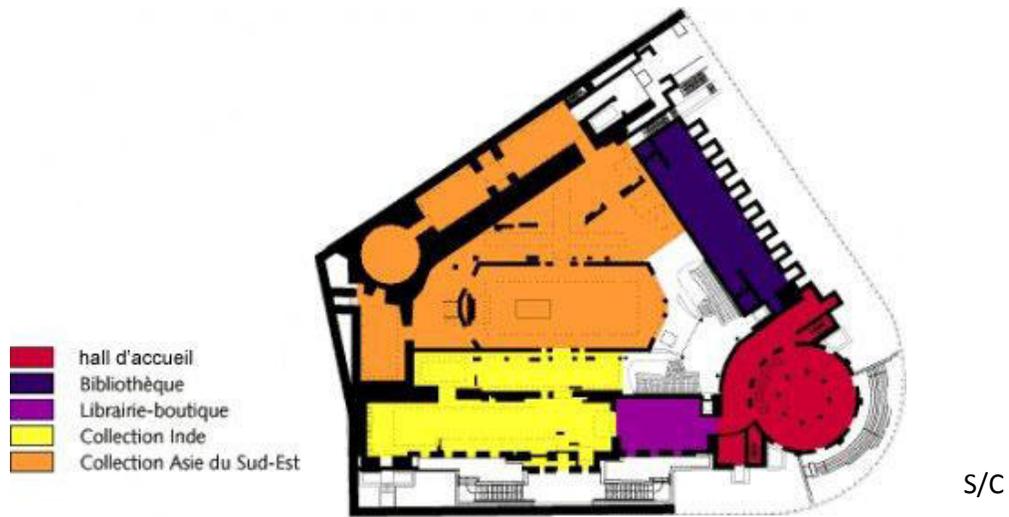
Plano del primer piso del Museo Guimet, París Francia
